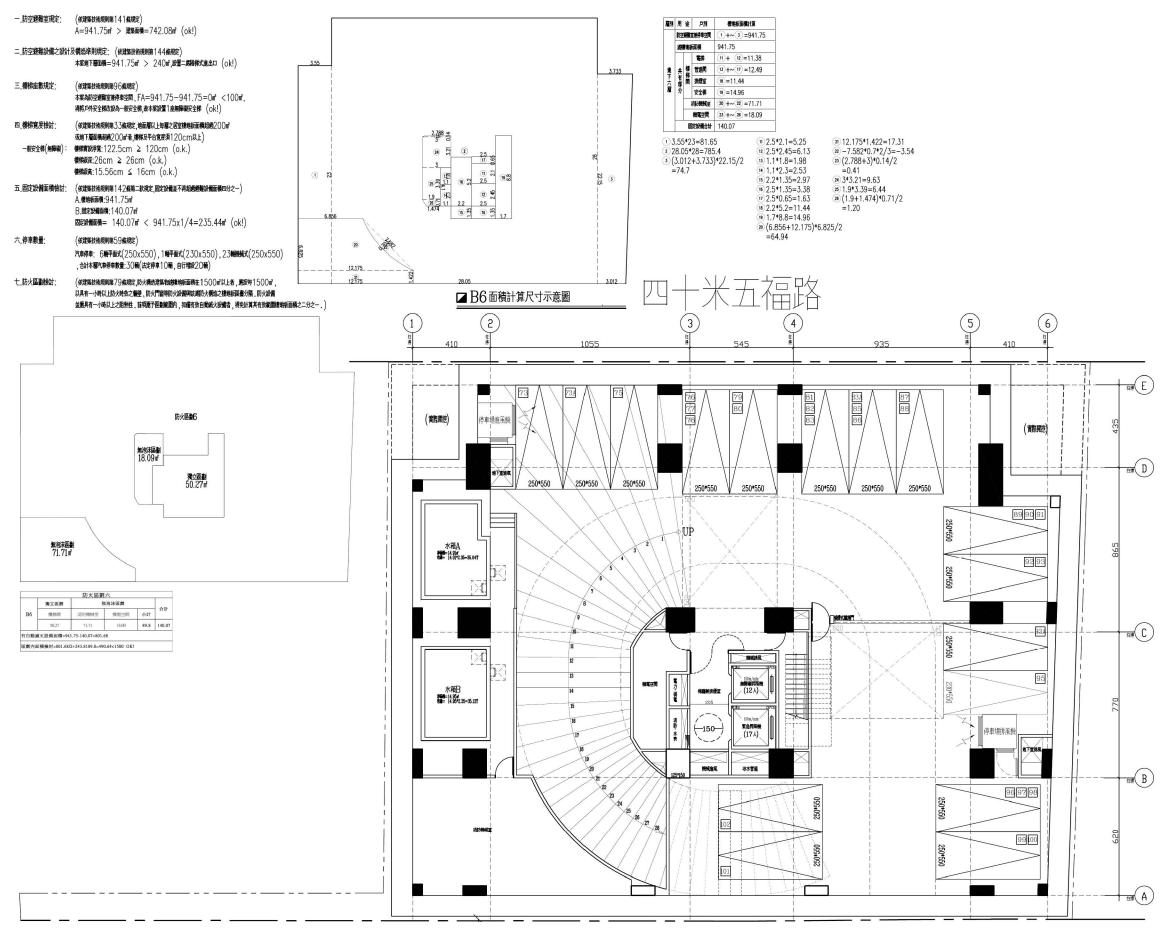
地下 6 層平面圖 (比例尺 1/200)
